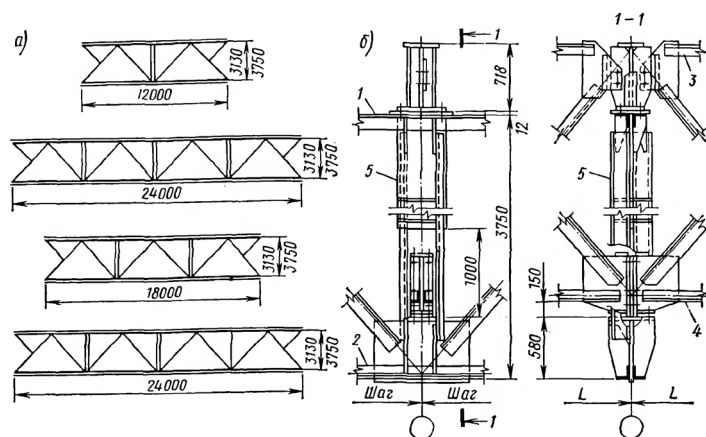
Металлические подстропильные фермы пролетом 12; 18 и 24 м:
